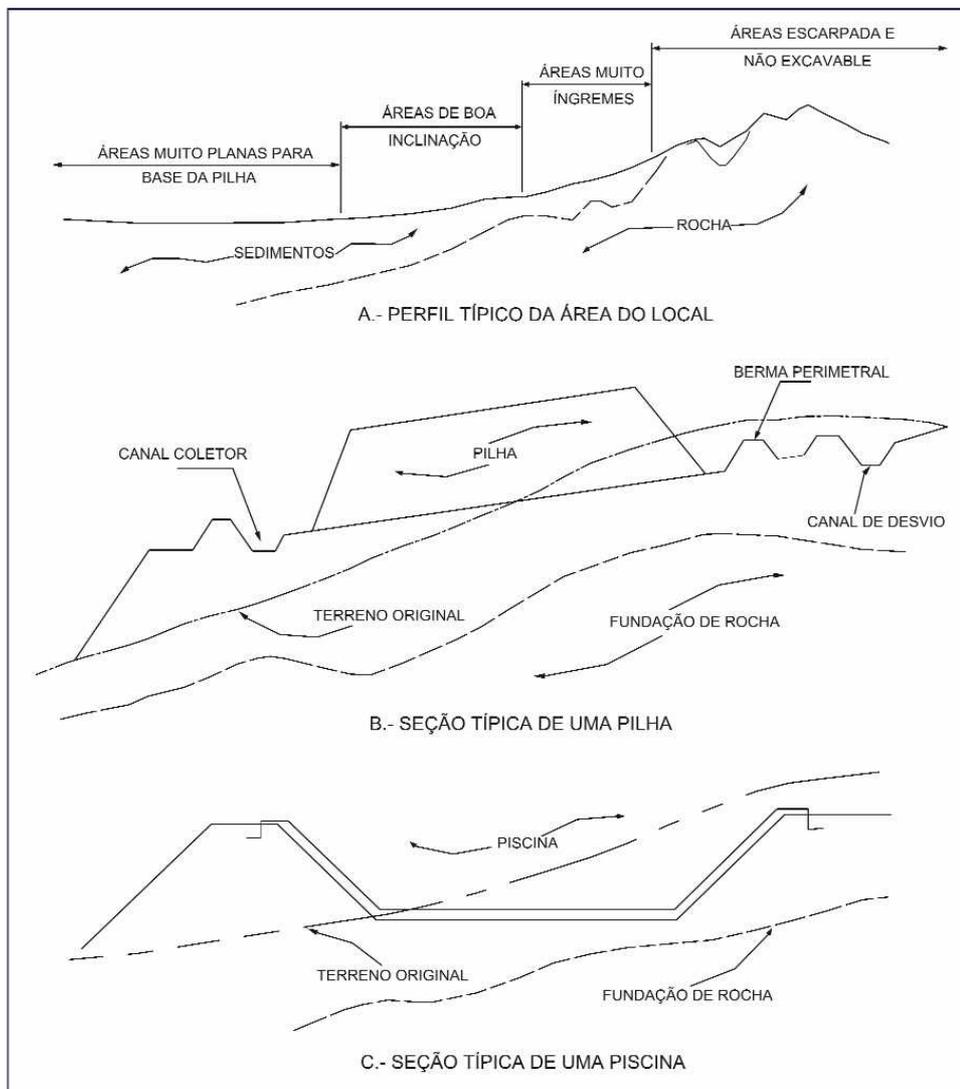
Aspectos gerais do local de construção da pilha ((Strachan e Dorey, 1988)
